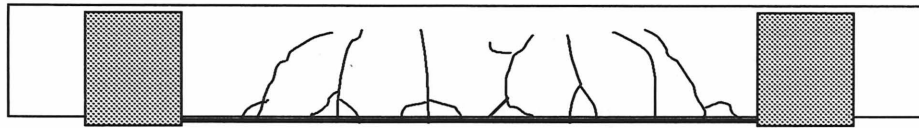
Réseau de fissuration d'une poutre typique renforcée de Replark 20 (P0-Repla-A)
